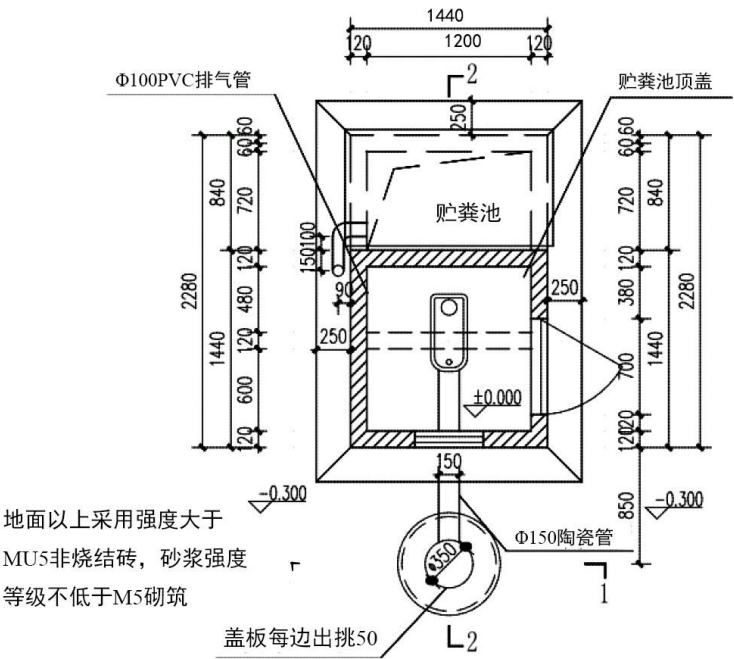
粪尿分集式生态厕所平面图（尺寸单位：毫米）
